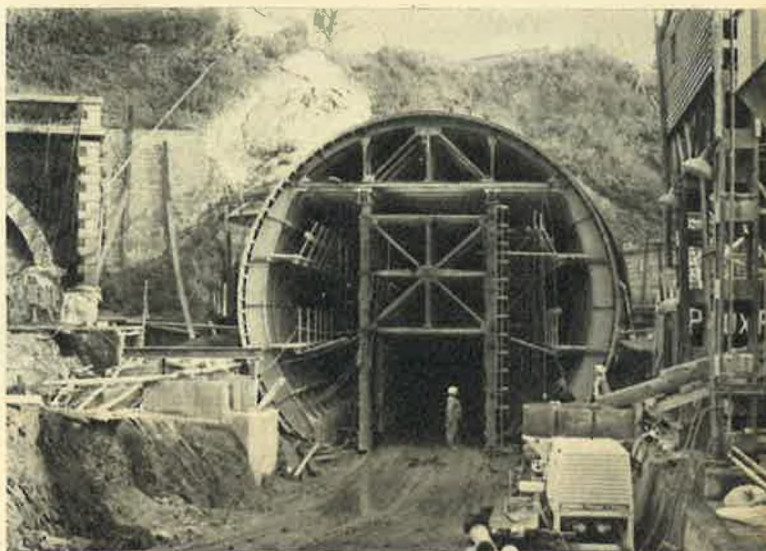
monteren van de bekistingssteun voor het betonneren van het gewelf.
